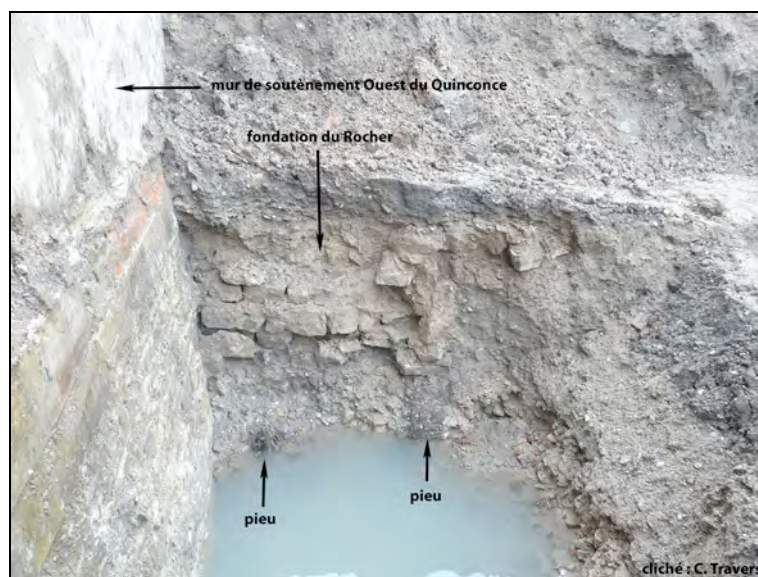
Vestiges de la fondation du Rocher – Coupe E-0 du sondage S.XXI
